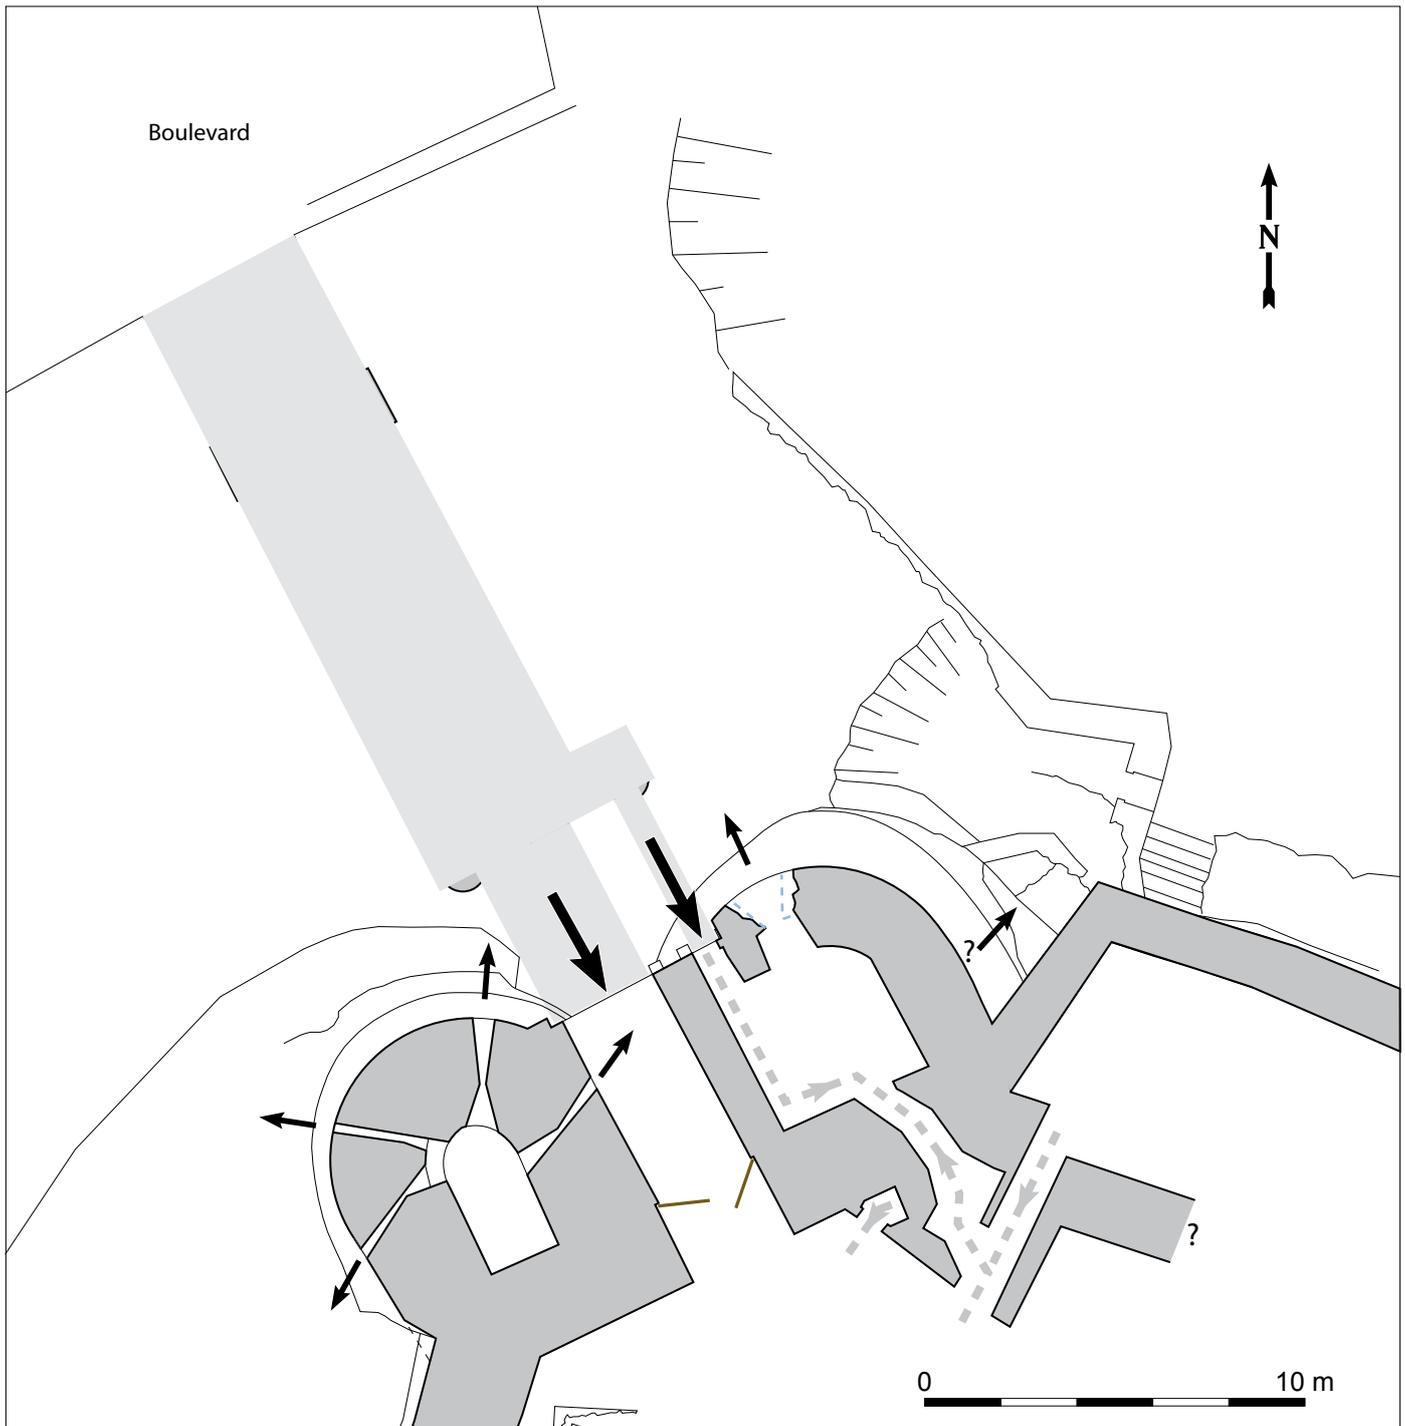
Plan restitué du rez-de-chaussée du châtelet à la fin du XV^e siècle (SADML).
